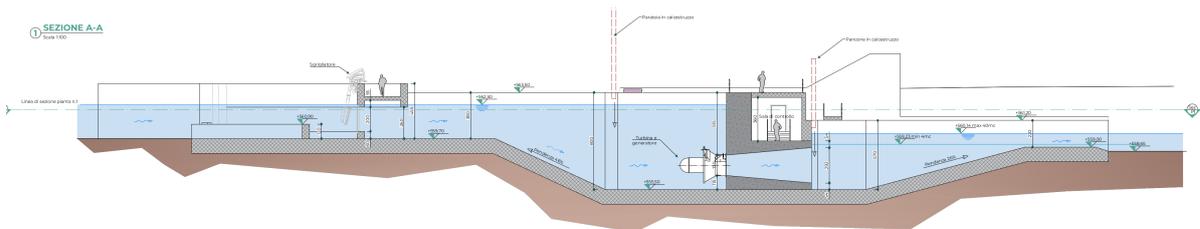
Sezione longitudinale dell'impianto in progetto.
